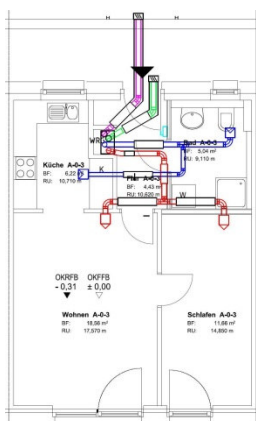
Wohnungsbeispiel (Grundriss)
